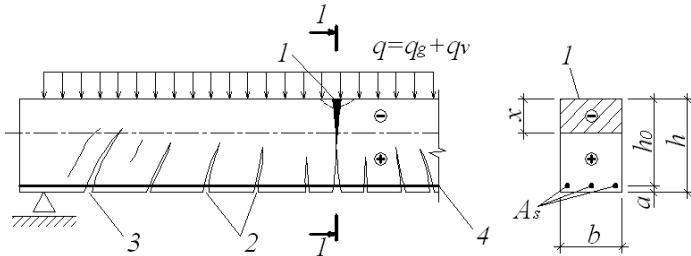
К расчету изгибаемого элемента с одиночным армированием:
